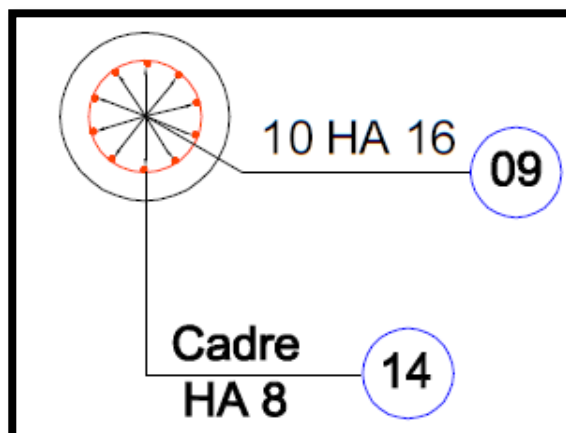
Ferrailage des poteaux (Ø50).
